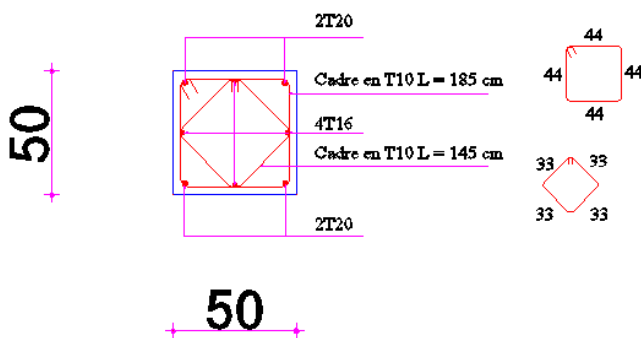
ferrailage de poteau (50x50) Figure V.2 : ferrailage de poteau (45x45)
